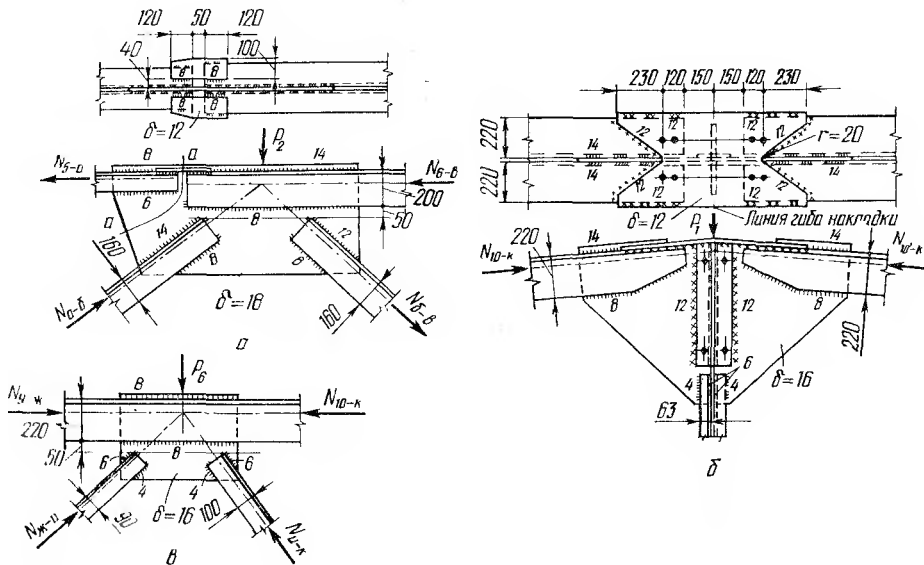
Узлы фермы (ригеля) из уголков:
